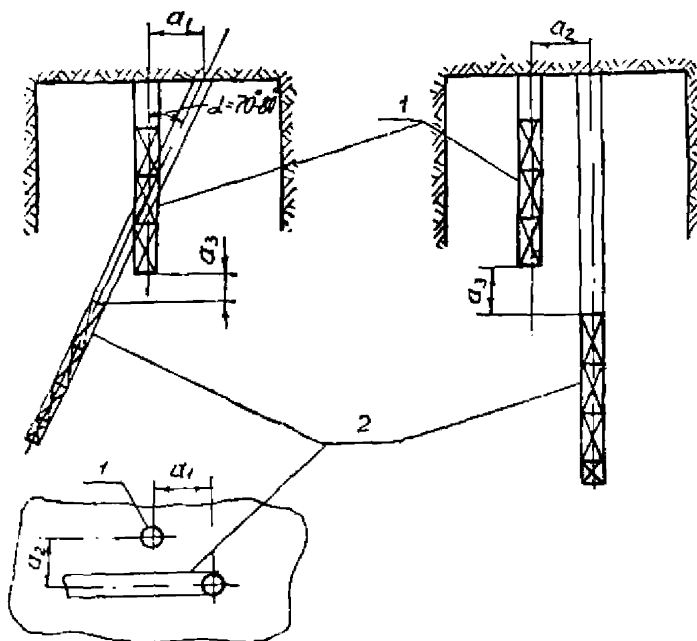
Схема расположения отбойных и запрессовочных шпуров:
